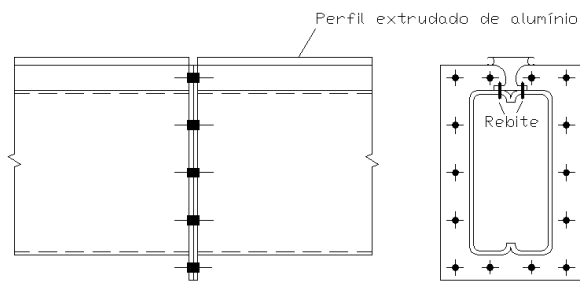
Esquema da ligação entre duas vigas no trecho reto
